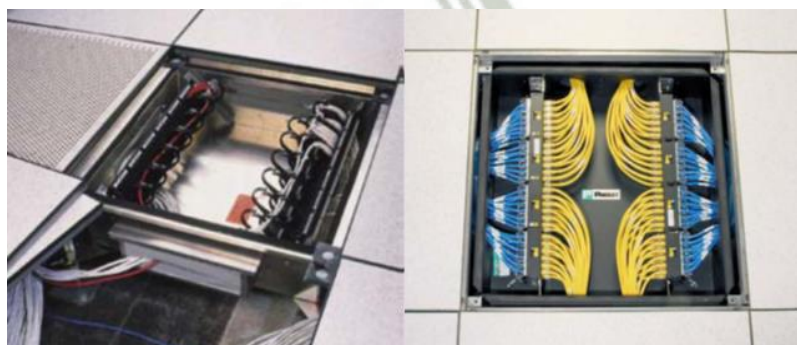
Área de Distribución Local ubicada en el piso falso
